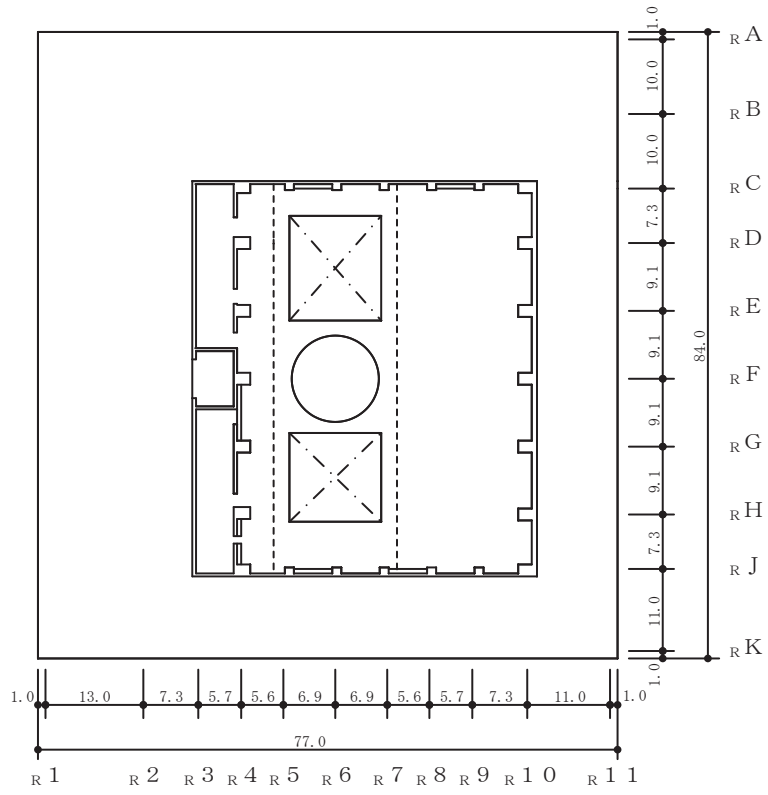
(4) 原子炉建屋の概略平面図 (0.P. 15.0m)
